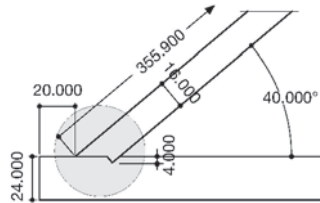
zeigt einen Ausschnitt aus einer CAD-Werkzeichnung für ein einfaches Hängewerk.
